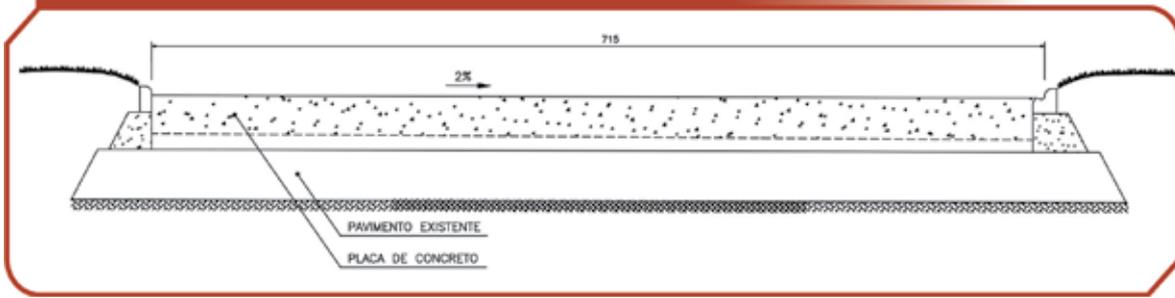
Seção-tipo do pavimento de concreto – canaleta exclusiva – implantação pavimento novo
